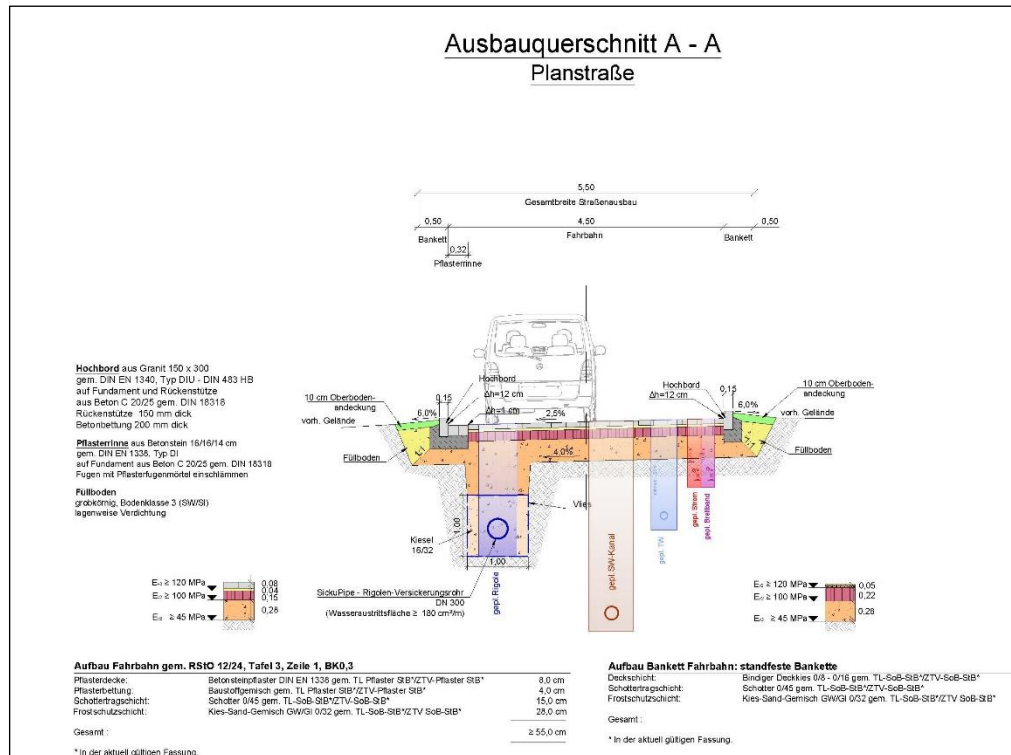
Straßenquerschnitt der Planstraße, Quelle Ingenieurbüro Möller, Ausführungsplanung Stand 03/2026
